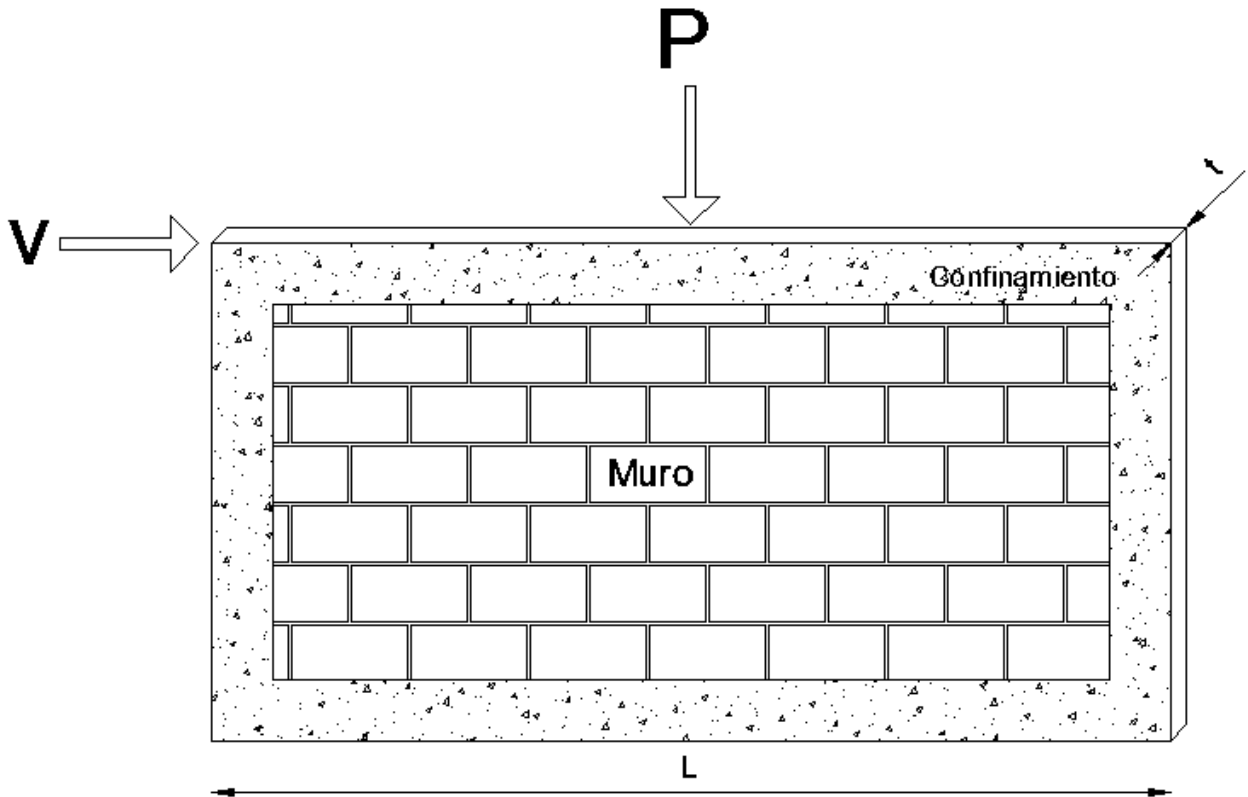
Esquema de elementos mecánicos del muro de mampostería confinado.
